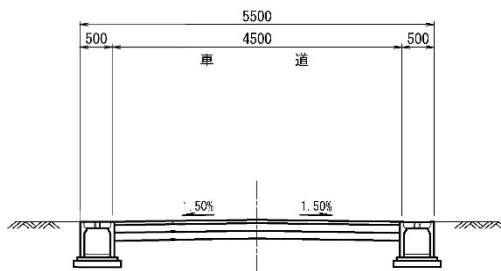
(5) 標準断面図 (区画道路 幅員 5.5m)
